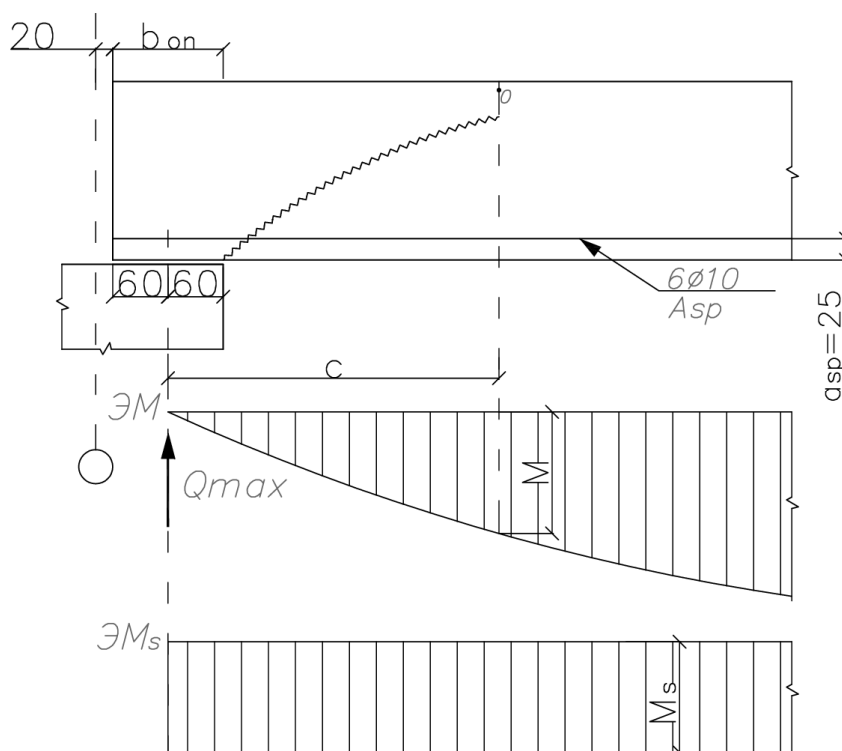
Расчётная схема узла опирания плиты на ригель, эпюры моментов.
